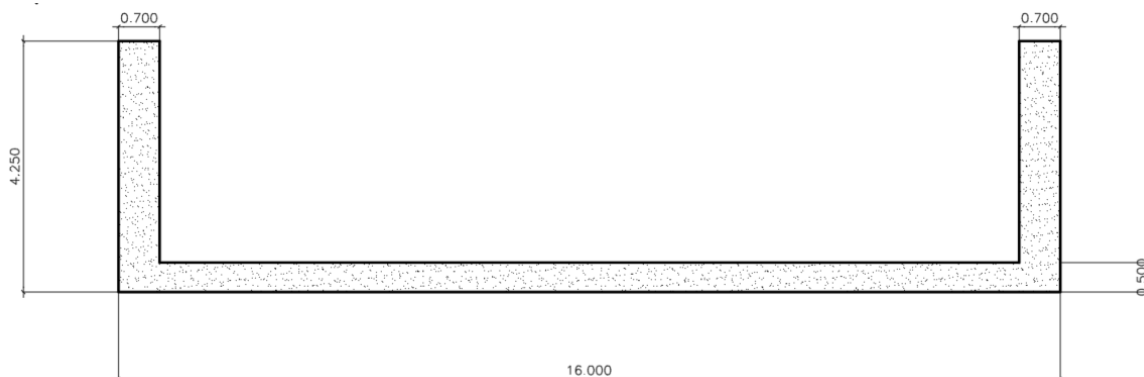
Dimensiones preliminares del muro “C”, en metros.
